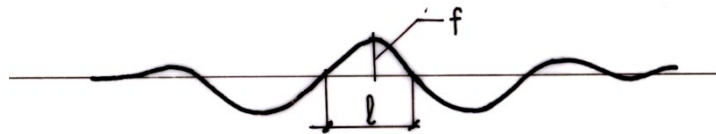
Pierderea stabilității căii în plan orizontal [24]
